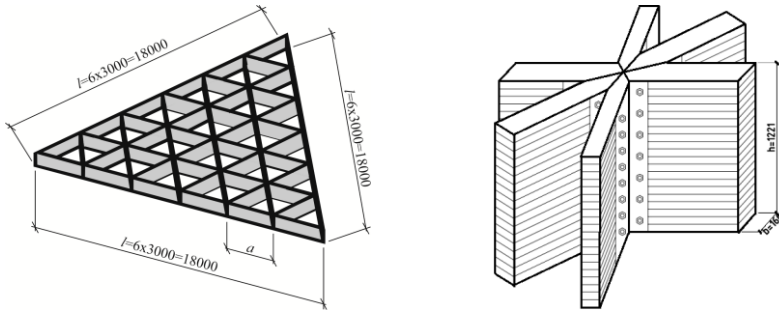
Схема системы перекрёстных балок на треугольном плане и узел примыкания элементов
